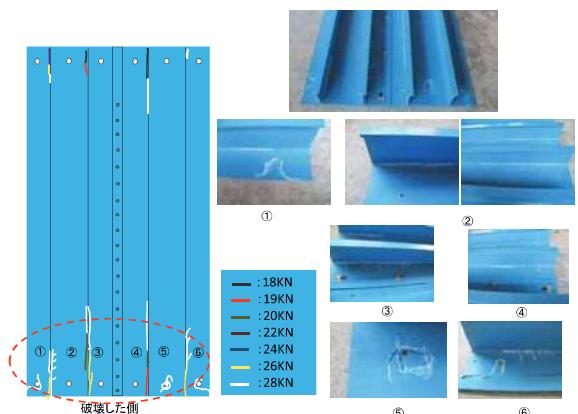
ひび割れ及び破壊状況図（クリップタイプ）
